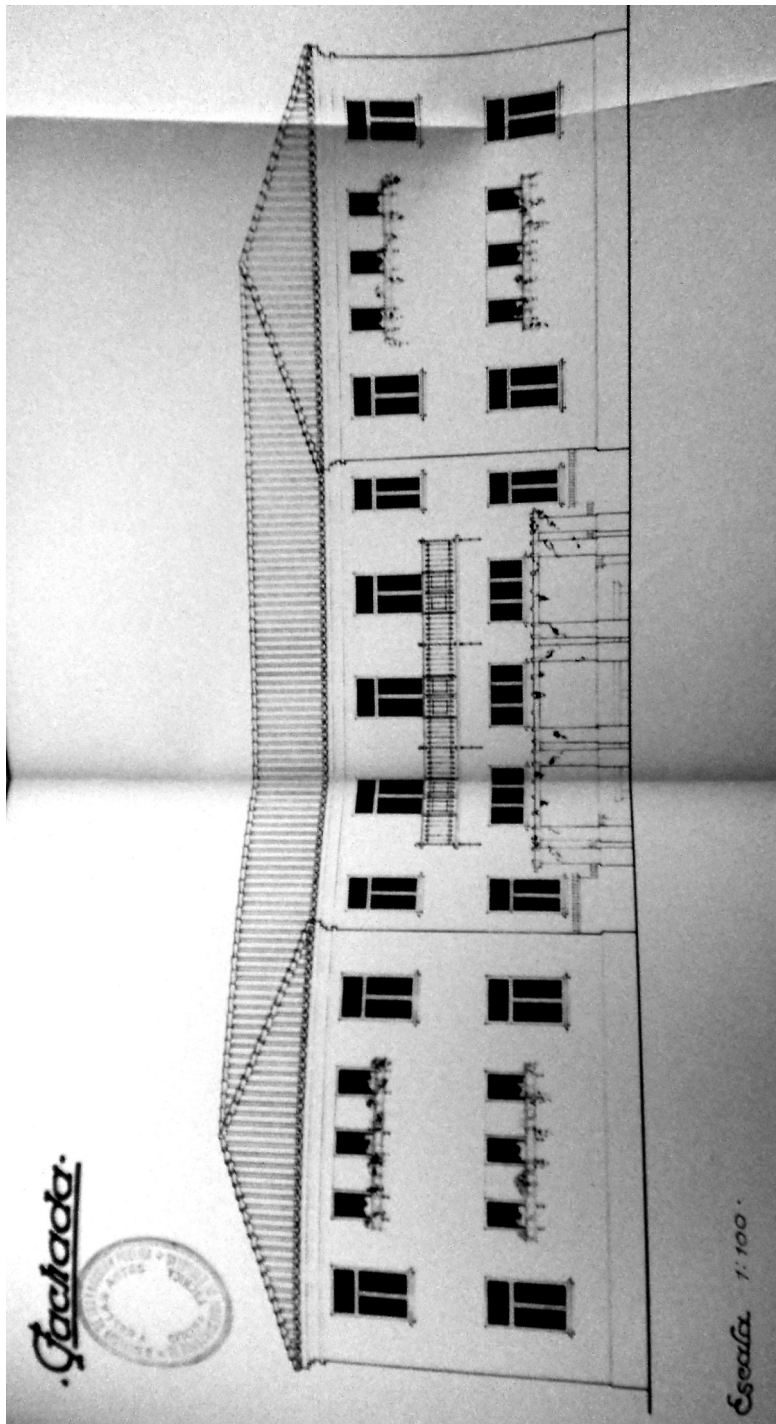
Plano de fachada de las Escuelas de Arriate (Escala 1:100)
